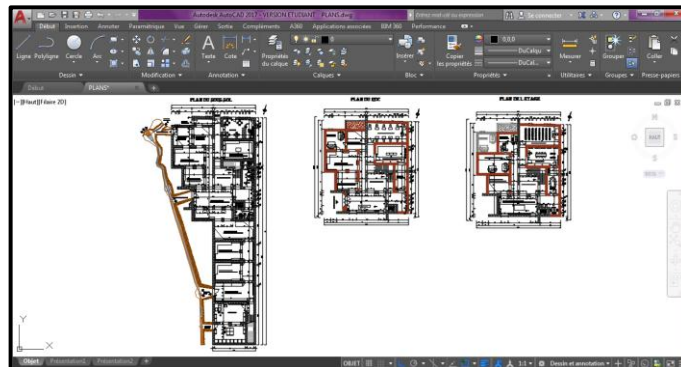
étape 1 voir les plans sur auto cad(Auteurs)
